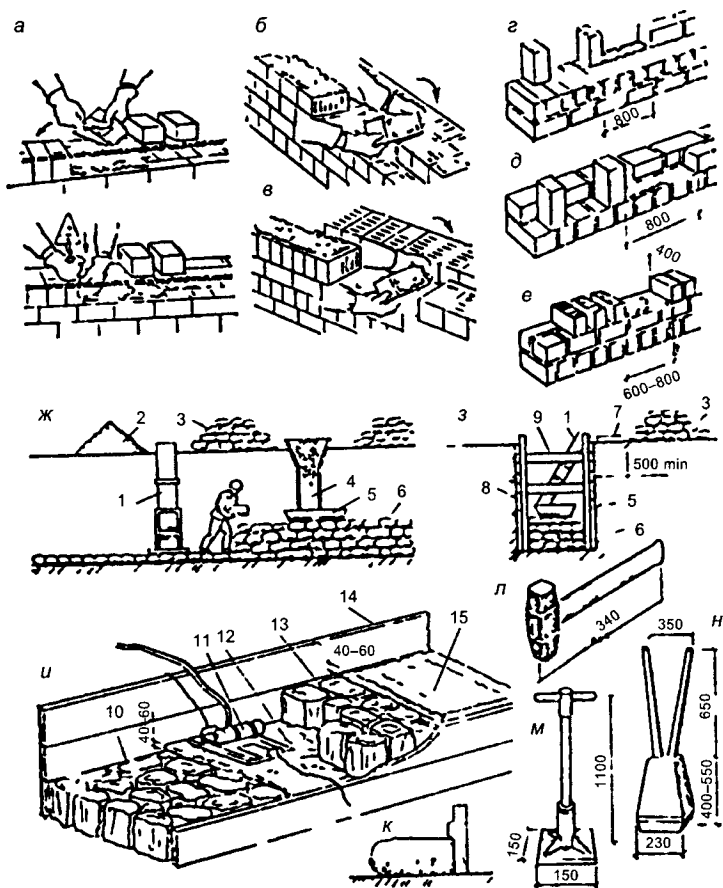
Кладка из керамических, бетонных и природных камней:
